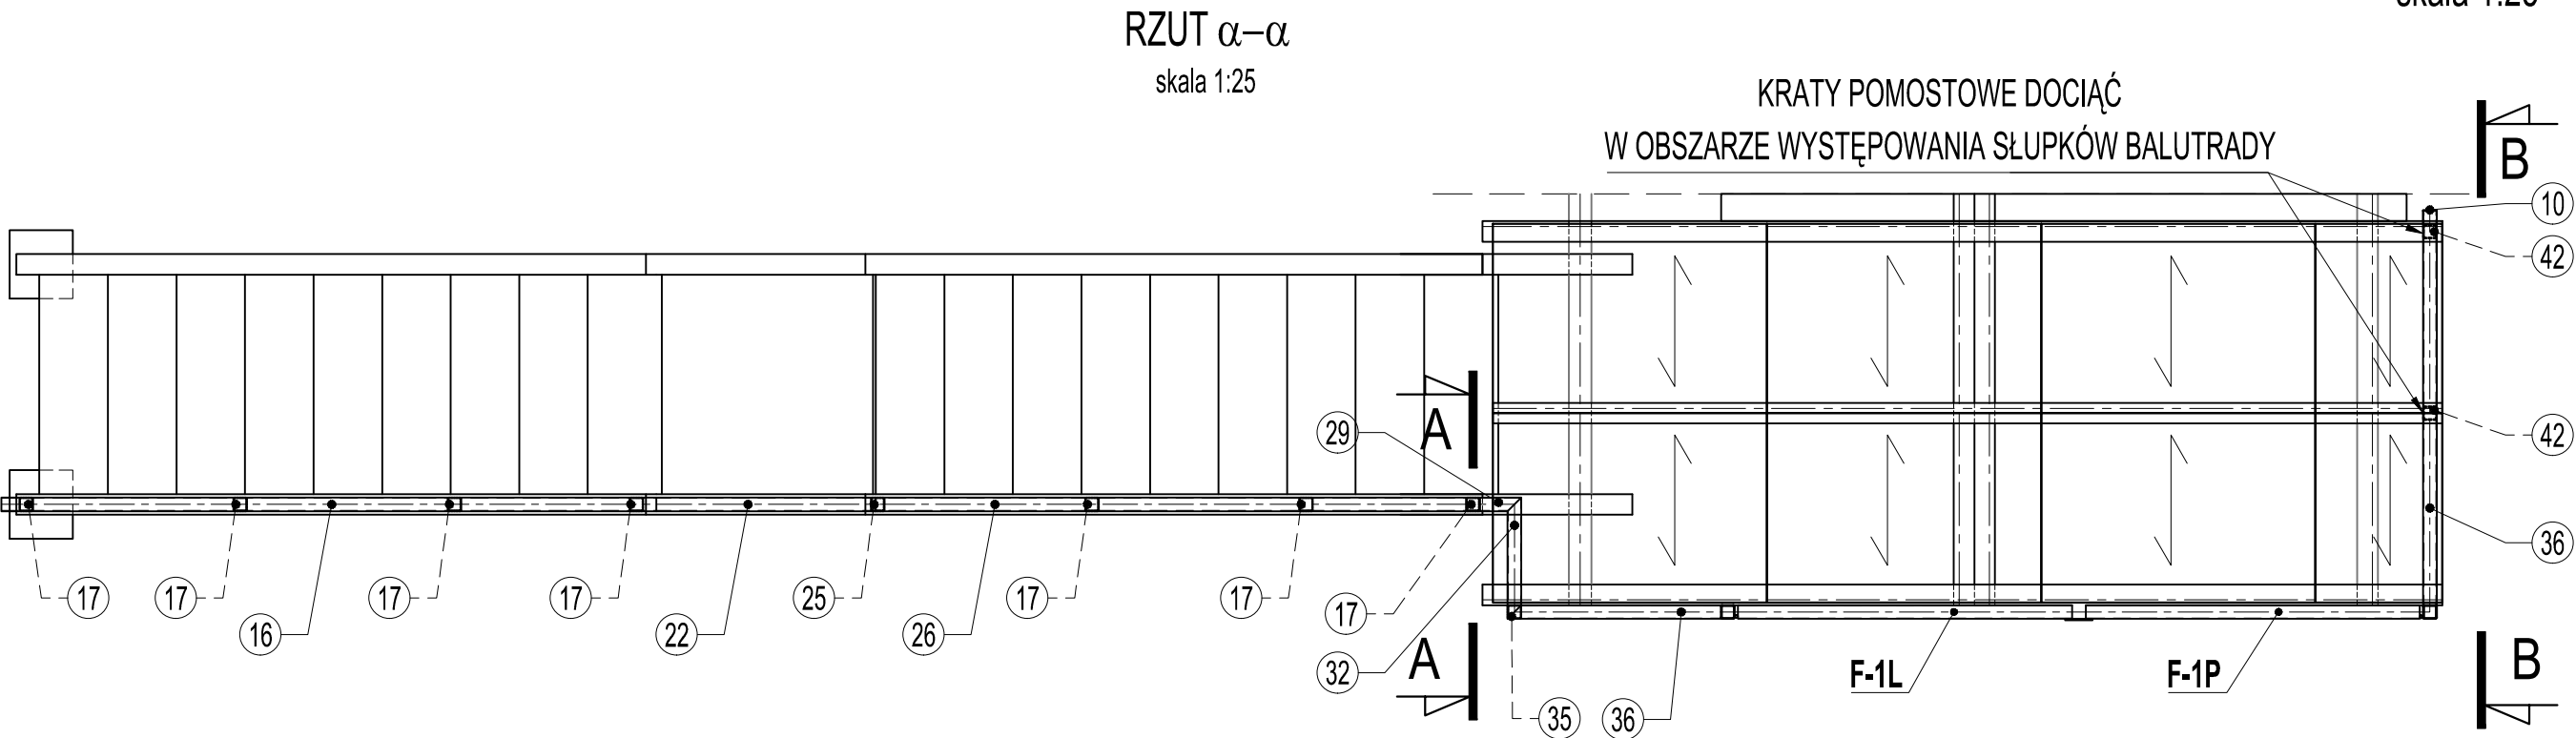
WIDOK KONSTRUKCJI BALUSTRADY
